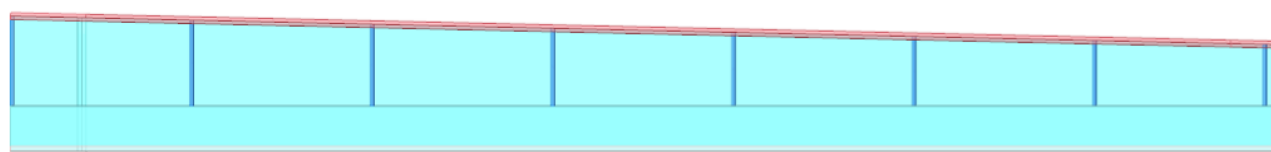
Vista 3D del Modello Strutturale FEM – Corpo B – Vista Prospettica Longitudinale – Stato di Progetto
